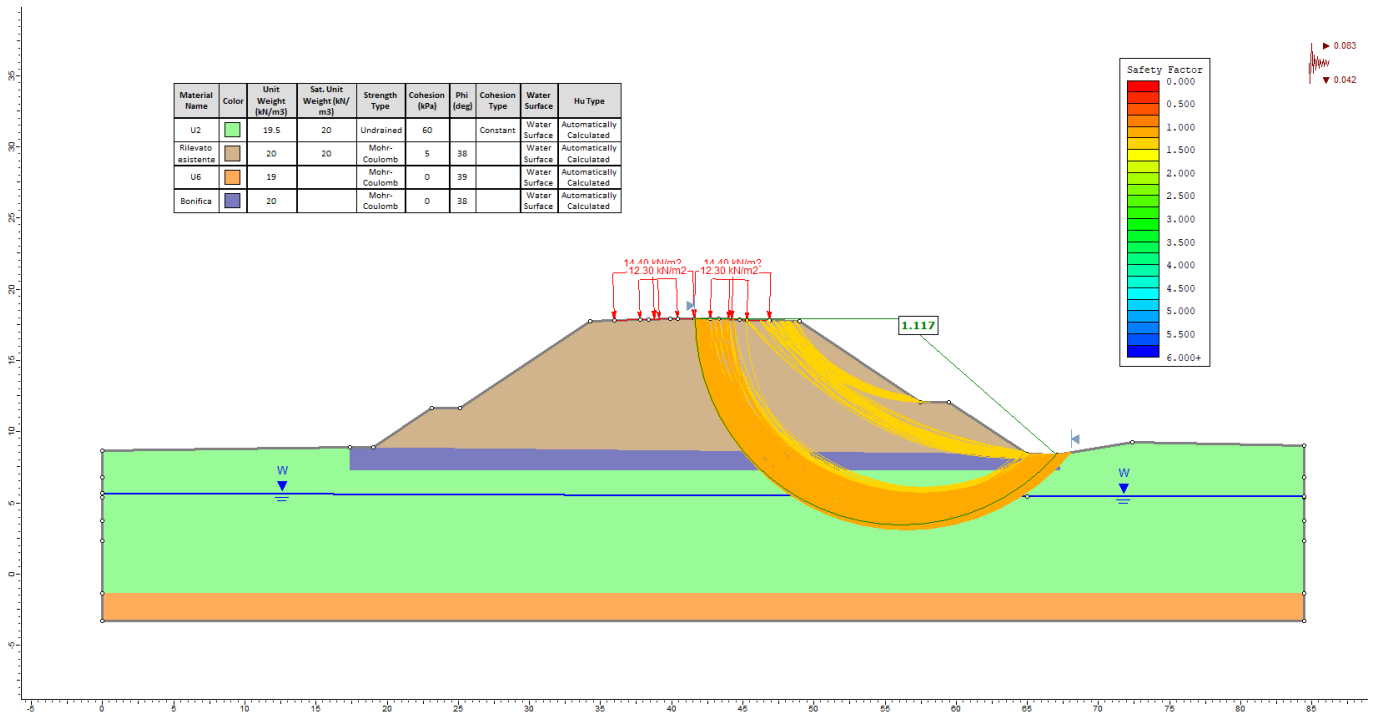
Rilevato sezione n° 16 pk 183+126 - Analisi SLU in campo sismico
